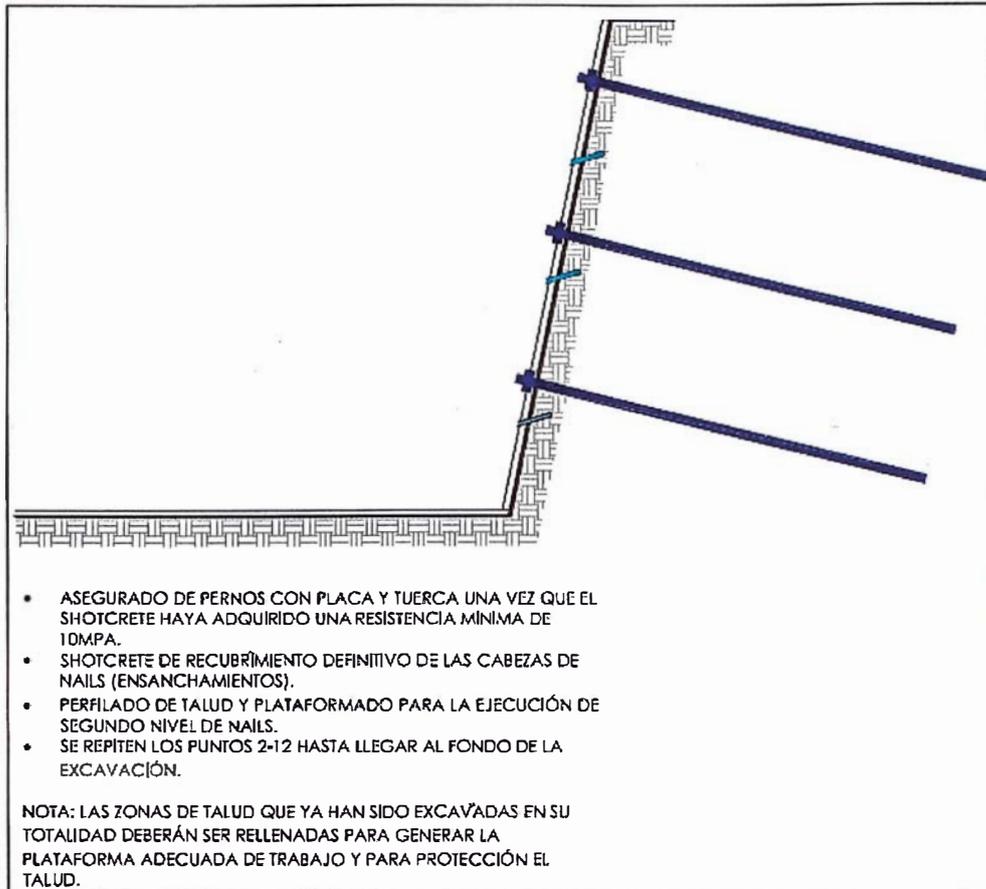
Secuencia constructiva de los siguientes niveles.
